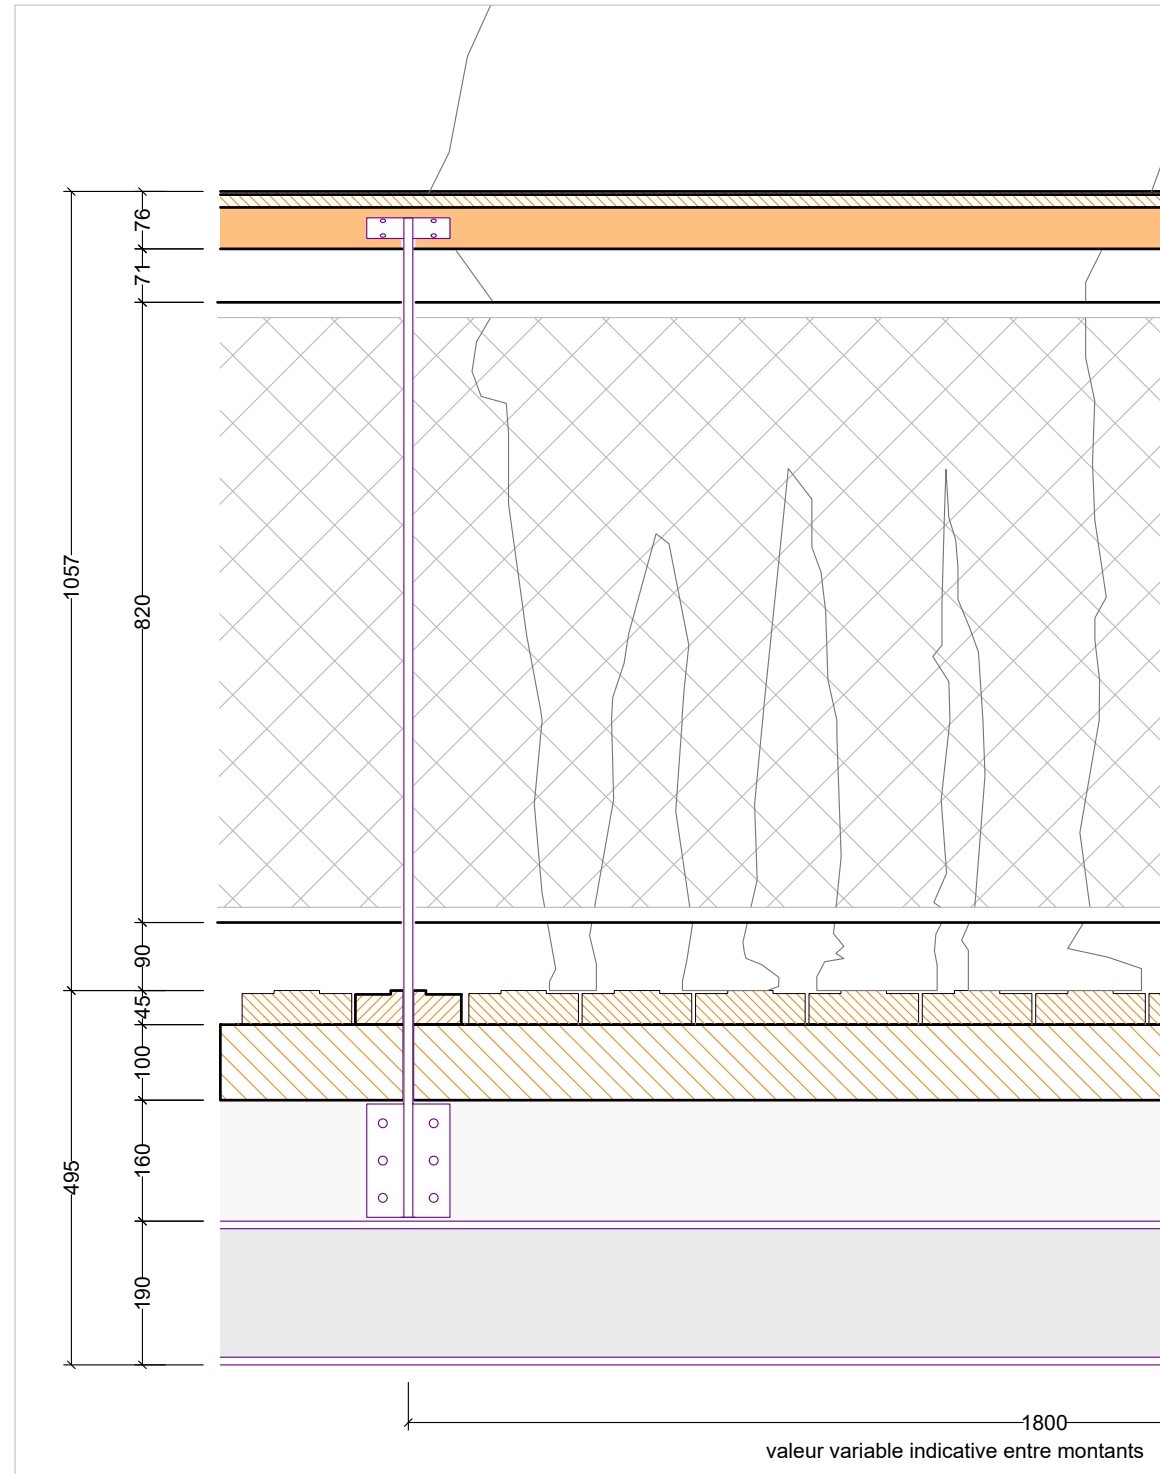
# DETAIL GENERAL DE PRINCIPE SUR LES PASSERELLES METALLIQUES
